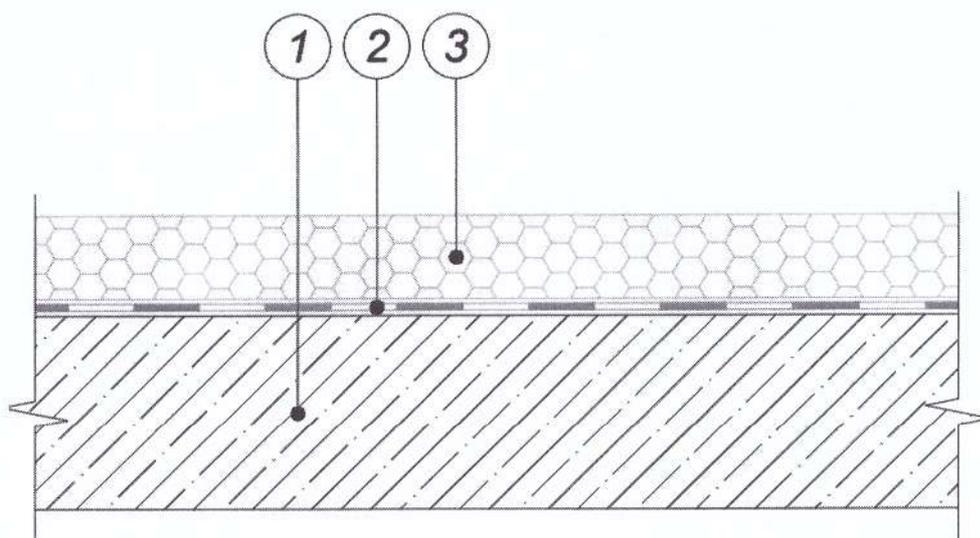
Схема конструктивного исполнения железобетонного чердачного перекрытия с системой утепления ТН-Чердак PIR (вариант 24)
